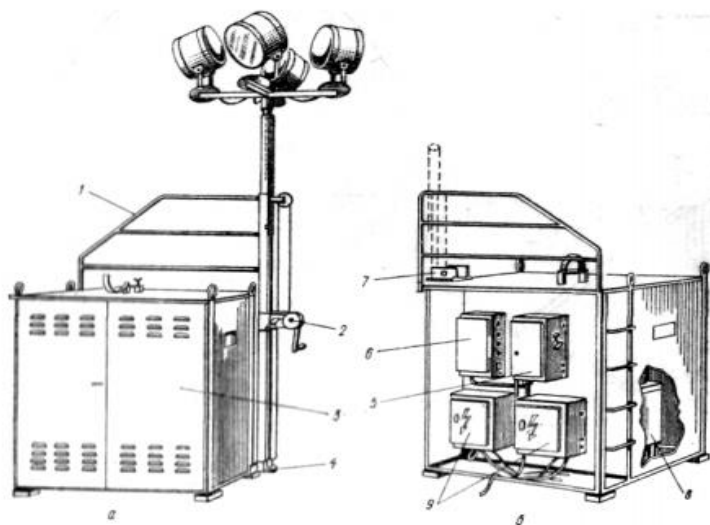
Телескопічна прожекторна вежа: а – загальний вигляд; б – розташування зварювального трансформатора та приладів; 1 – огорожа; 2 – лебідка; 3 – контейнер; 4 – хомут для закріплення щогли; 5 – ввідний рубильник; 6 – щит електростояка; 7 – вісь обертання щогли; 8 – зварювальний трансформатор; 9 – відключаючі прилади холостого ходу зварювального трансформатора
